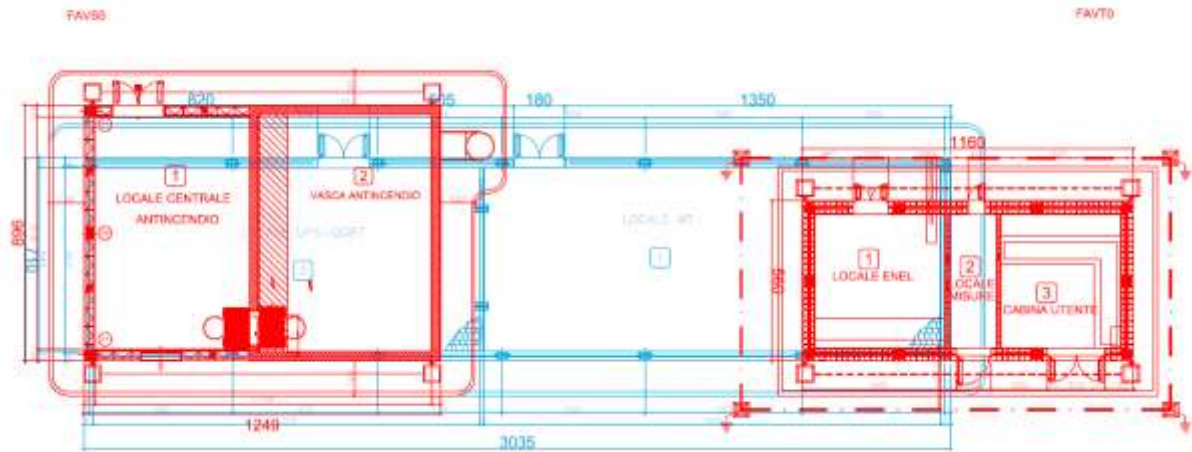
Pianta del piano terra del fabbricato nel Progetto approvato FA93 (in blu) e nel Progetto di variante FAVS0 e FAVT0 (in rosso).
